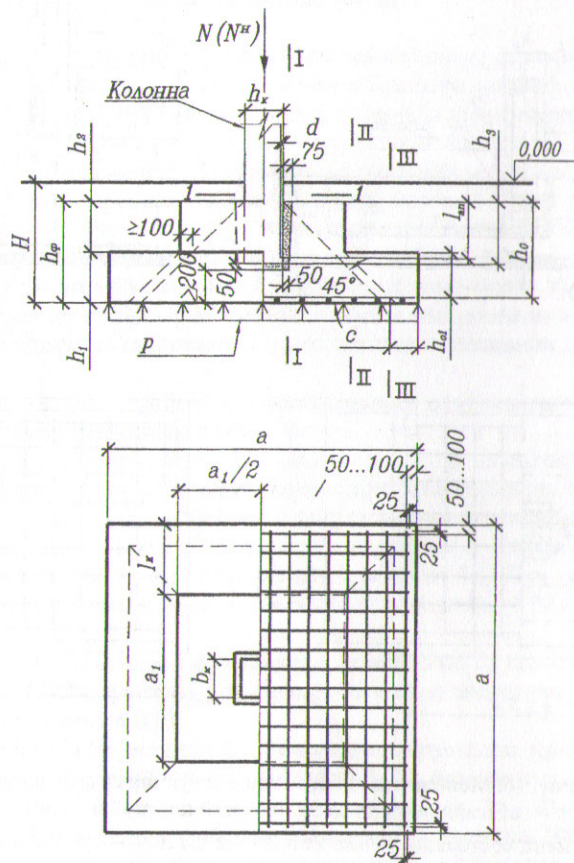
Схема к расчету монолитного центрально нагруженного фундамента под сборную колонну
